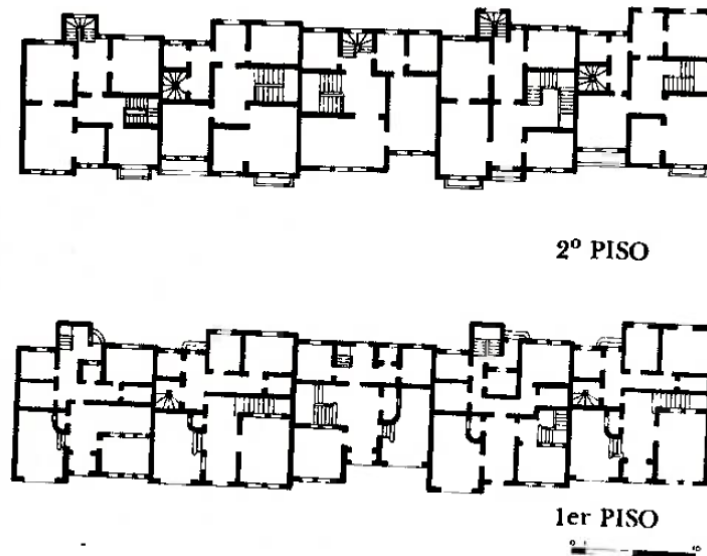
Planta conjunto 5 viviendas en calle Triana. Fuente: Boza y Duval (1982).
